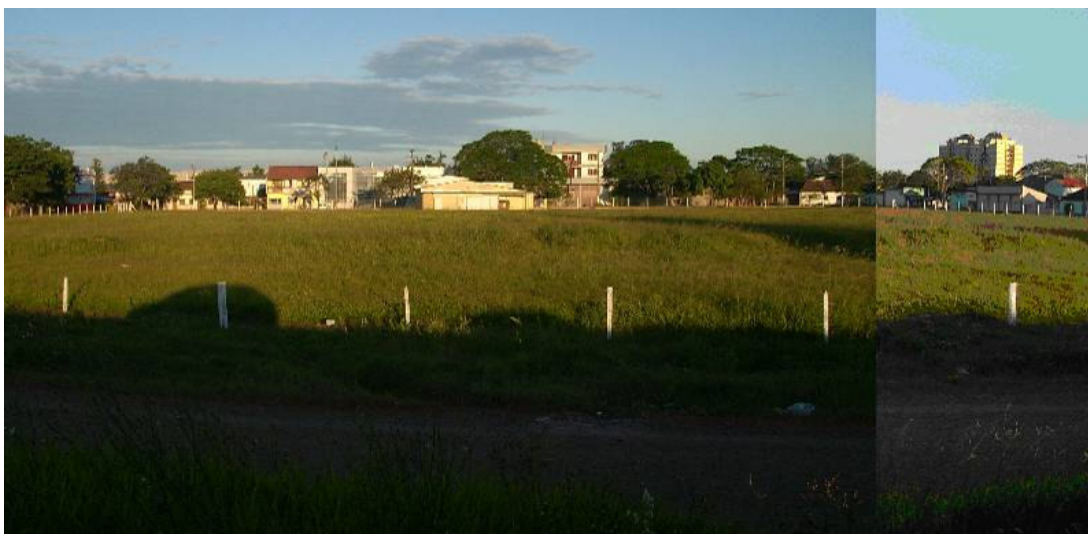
Tirada na Pista da BR-116, abaixo a Av. Senador Salgado filho (pista lateral) e o terreno.
